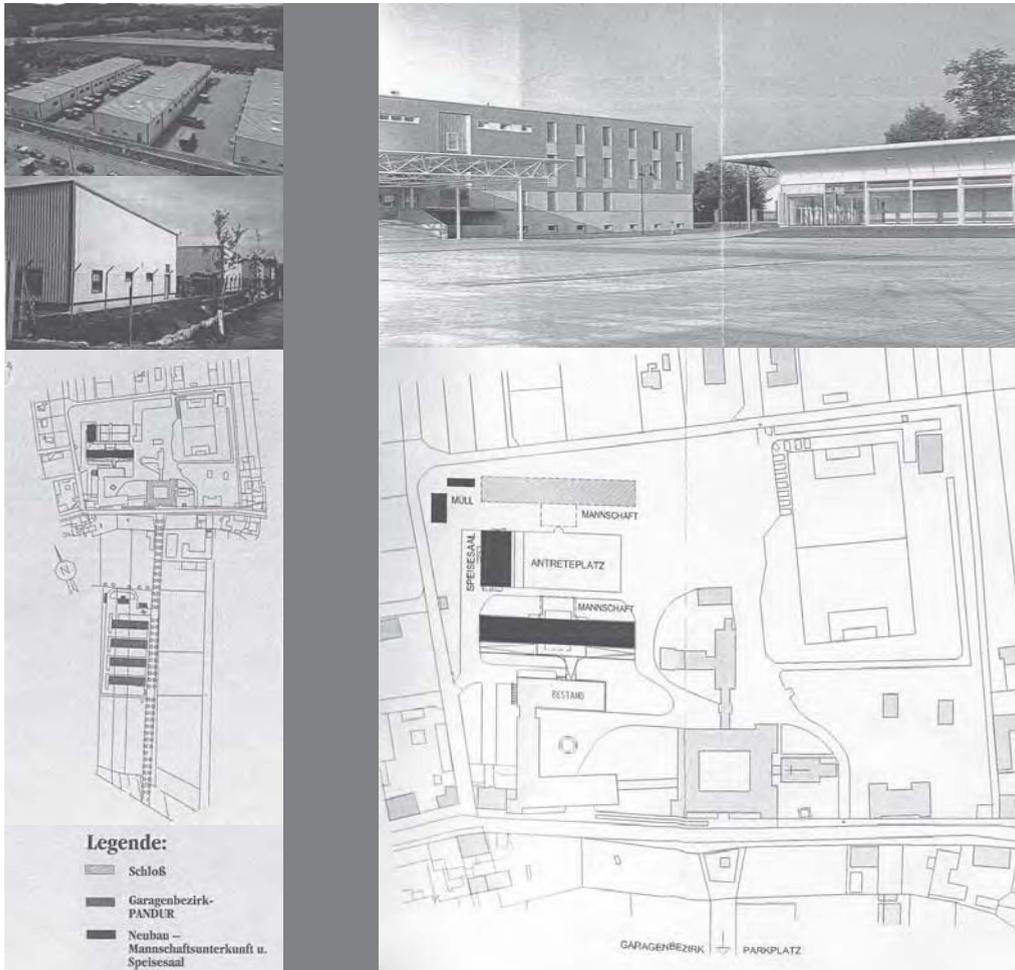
Bilder und Lageplan des Pandurgaragenbezirks (links) Abbildung und Lageplan von Kompaniegebäude und Speisesaal (rechts)
